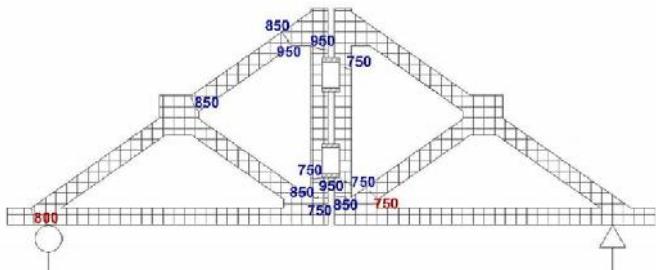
Pola Retak Kuda-Kuda Komposit Sambungan Grouting Tipe B-5 Pembebatan Vertikal Simetris
